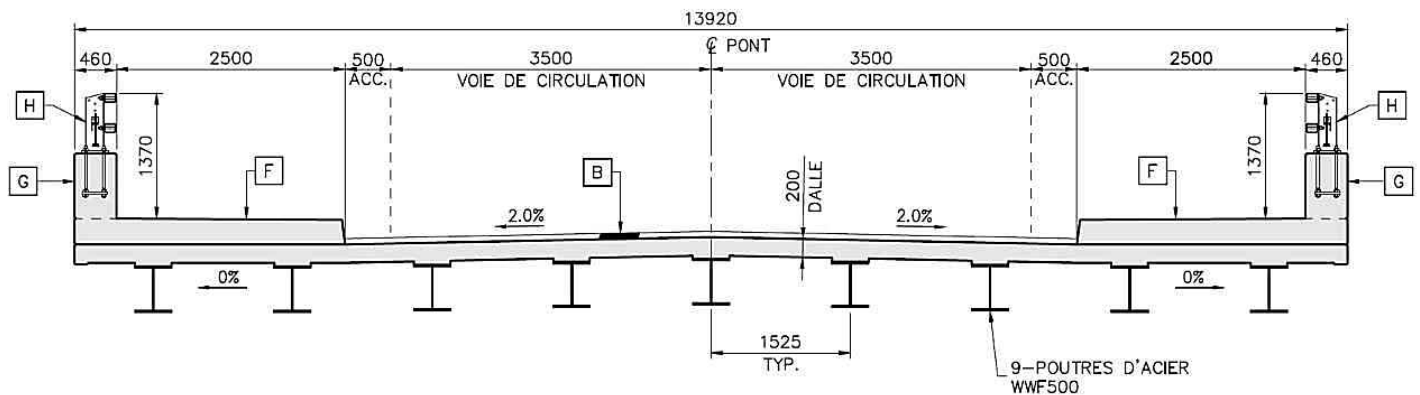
Extrait du plan d'ensemble du scénario 1 – Option poutres en acier – Coupe transversale type du tablier proposé
